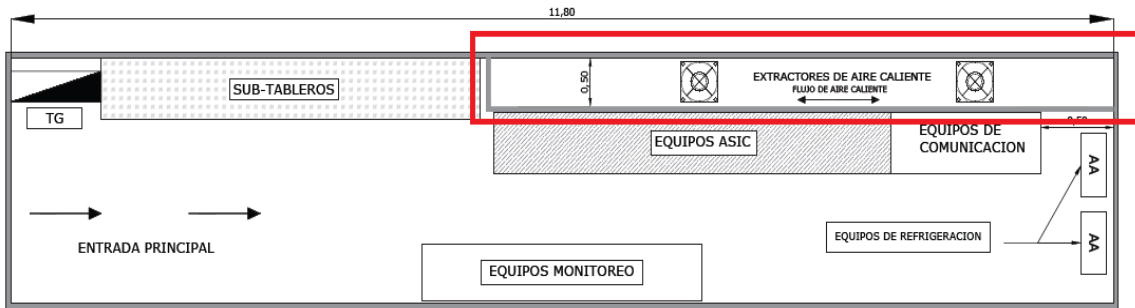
Vista en planta de esquema de separación de aire caliente
